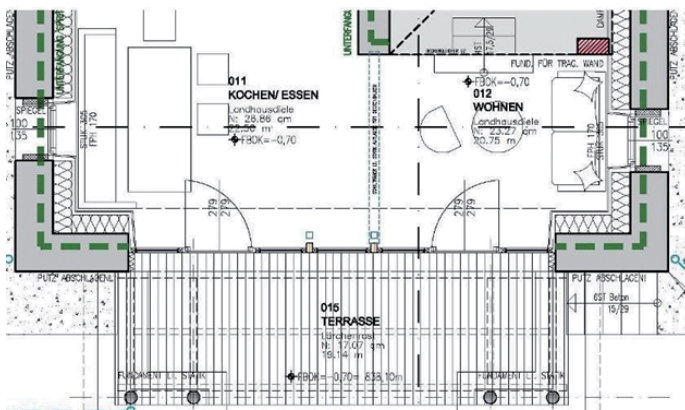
Grundrissdarstellung der Innendämmung
